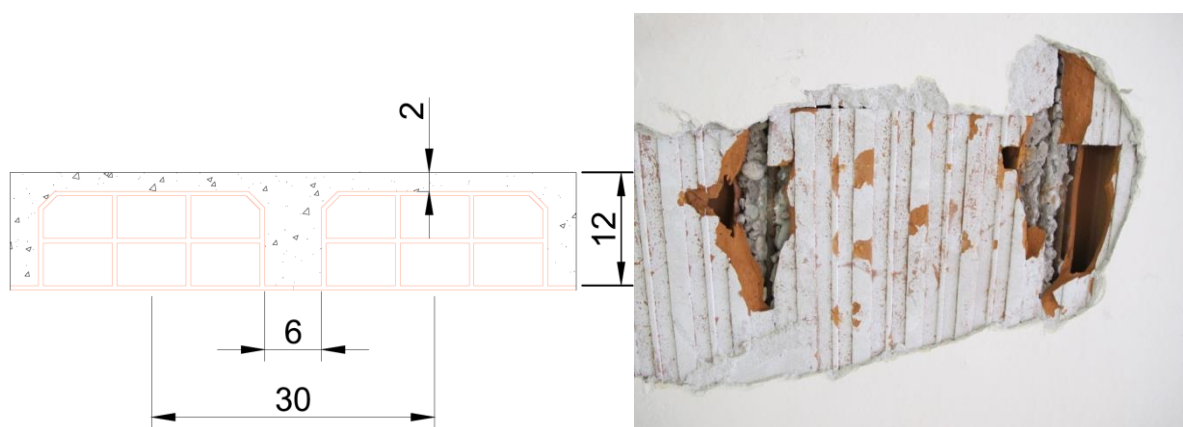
Intradosso e sezione del solaio di piano primo e secondo
